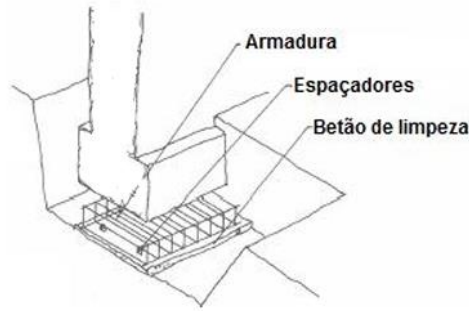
Colocação do betão de limpeza e da armadura de recalço (11).
